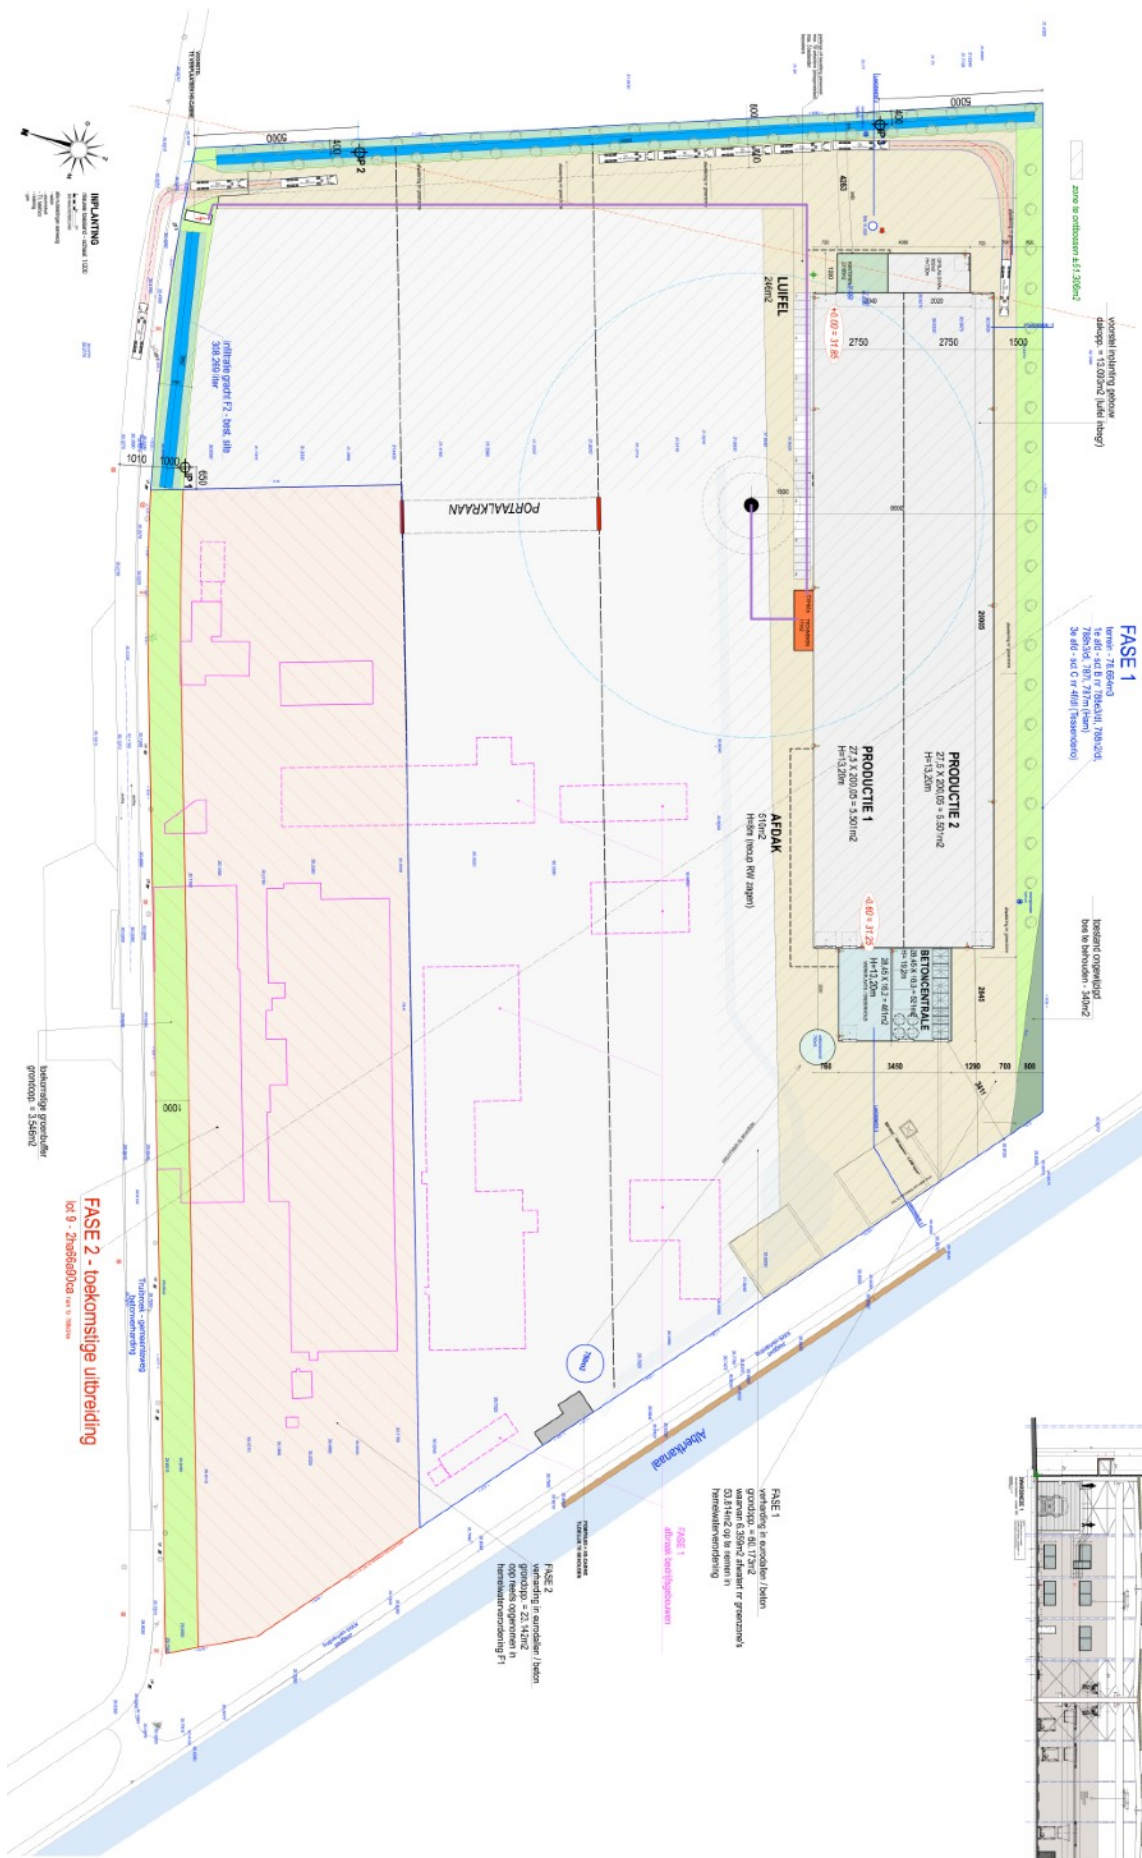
PLAN 14 Inplantingsplan. © AP/ART
